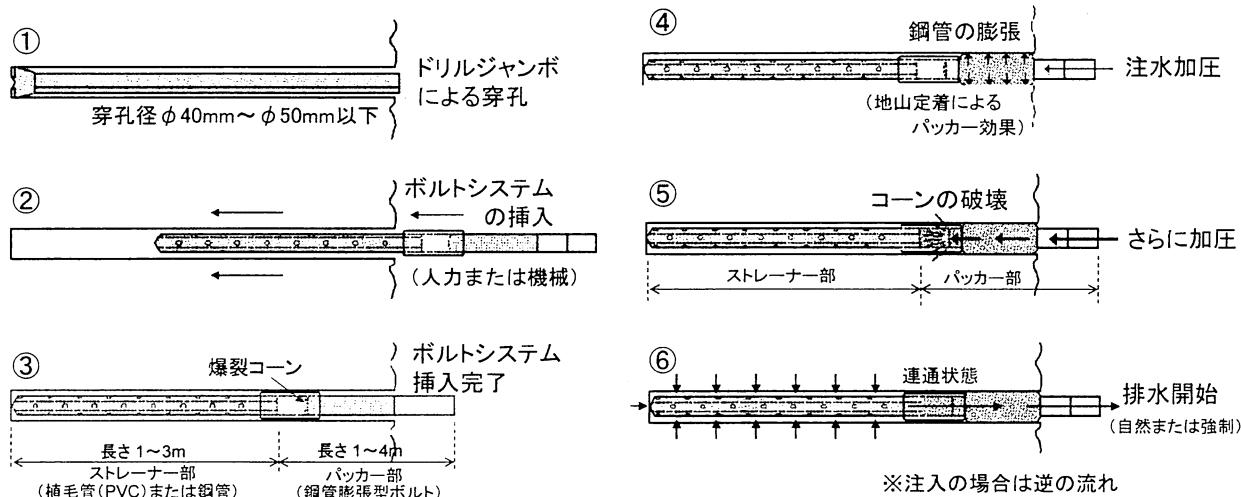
ボルトシステムの施工手順（設置～水抜き開始まで）
